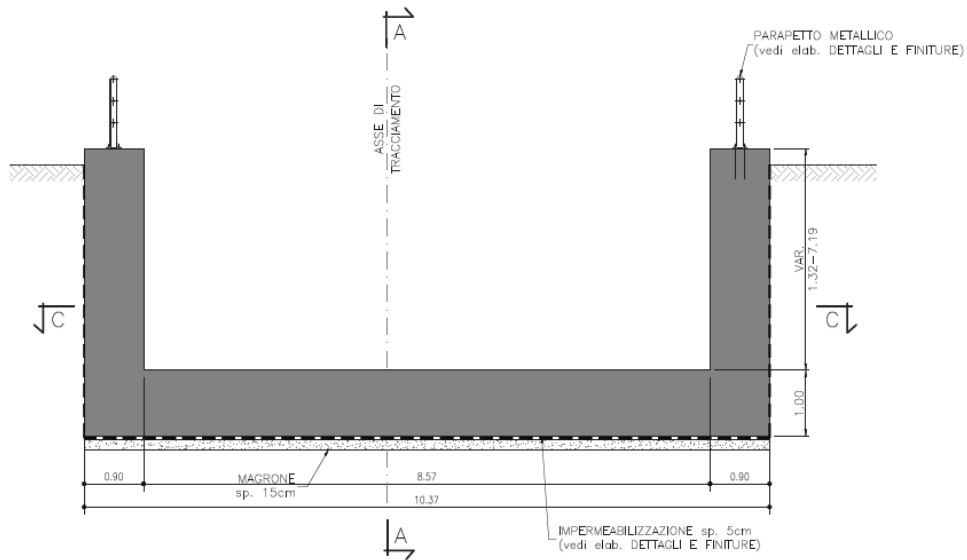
Muro d'imbocco - Sezione trasversale
